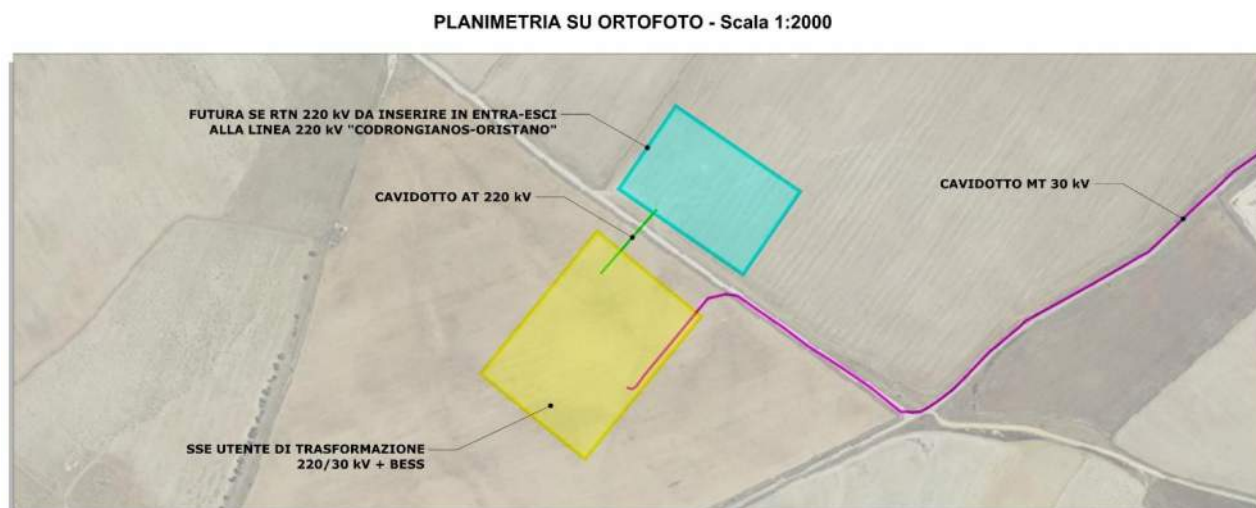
Planimetria su ortofoto dell'ubicazione della SSE Utente 220/30 kV
